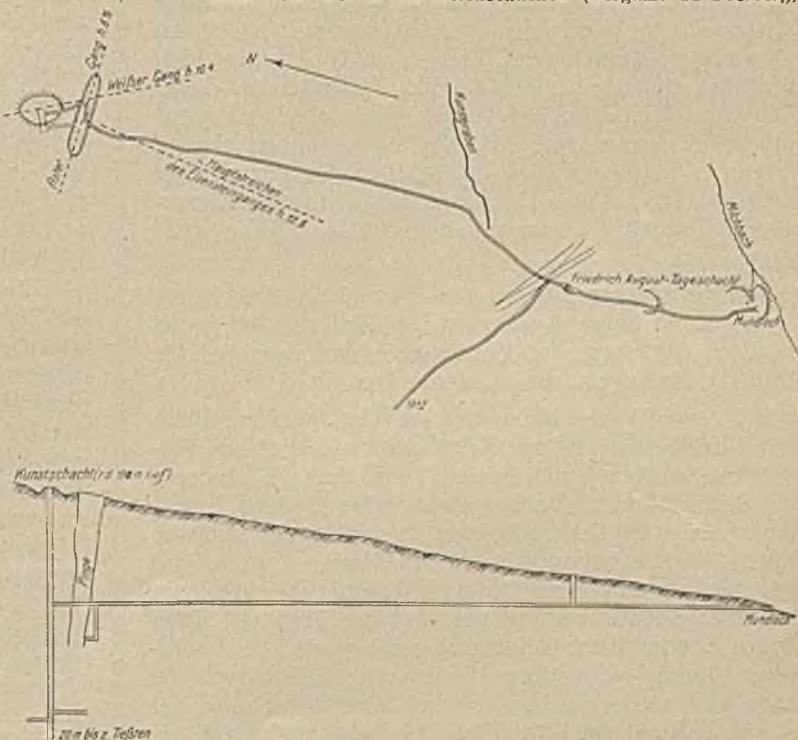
Rote Grube am Milchsachsen. Grundriß und Profil.
